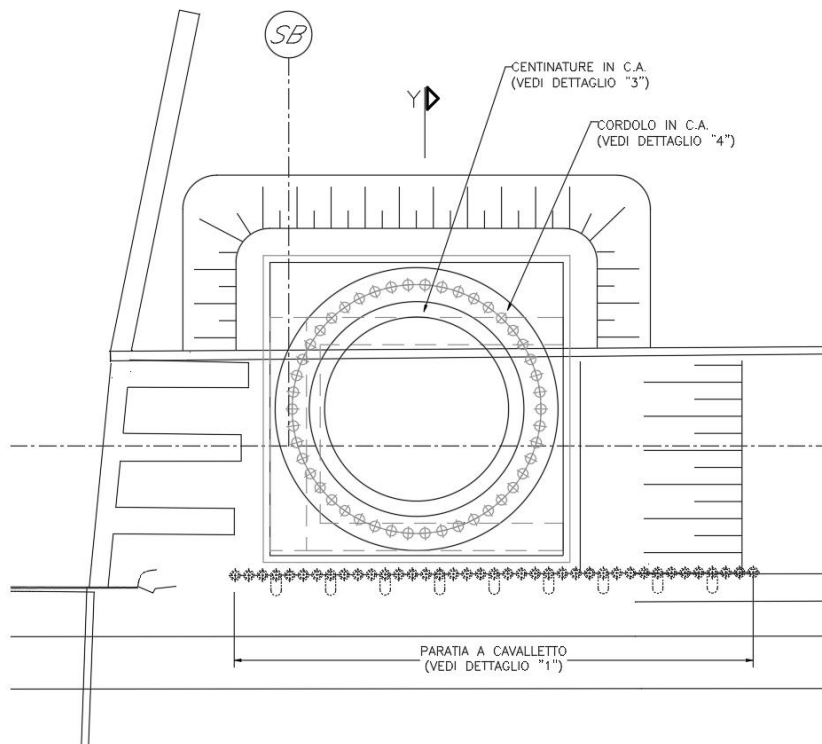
Pianta Opere Provvisionali Spalla B
